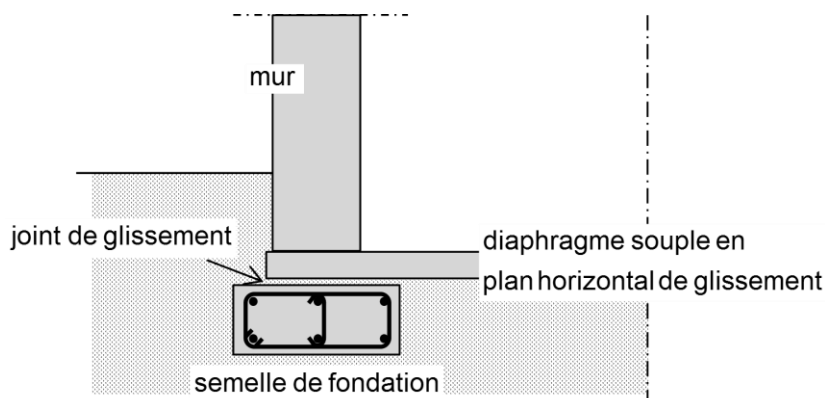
exemple de création d'un joint de glissement au-dessus des fondations
